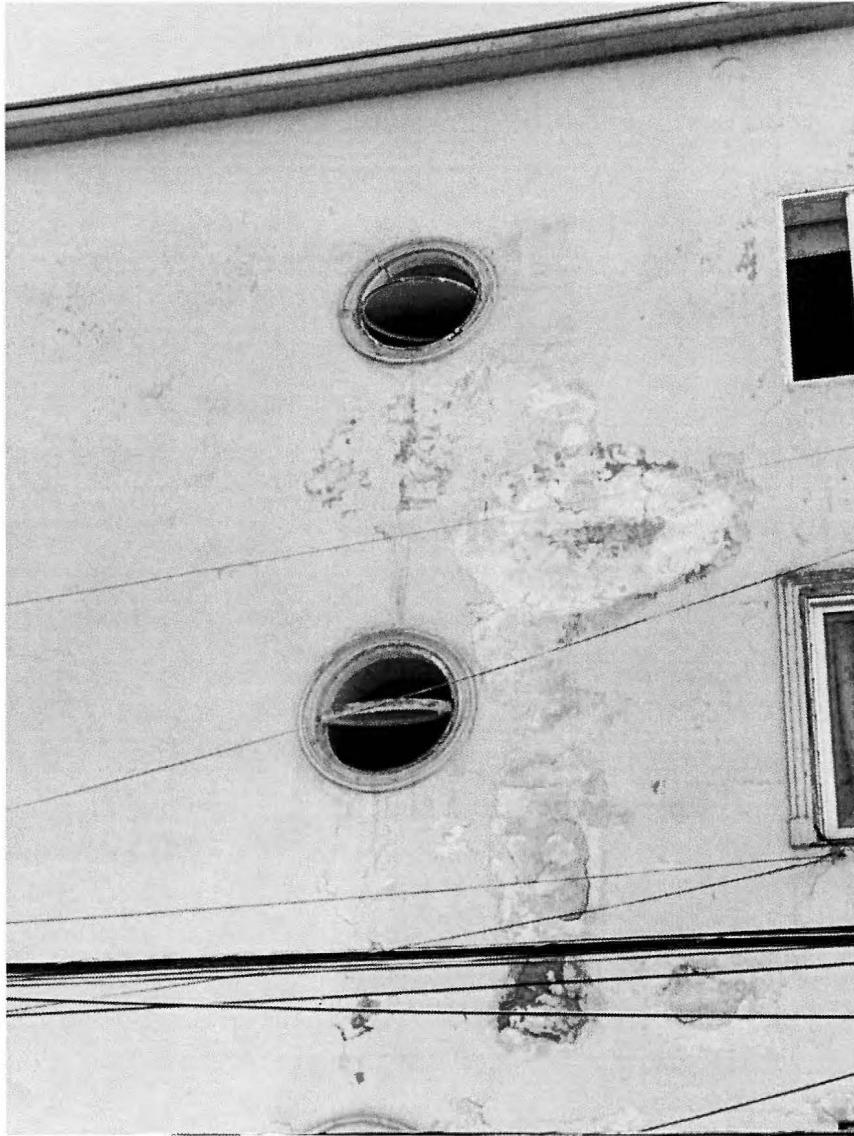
Fisuramiento de estucos en muros de fachada sur.
